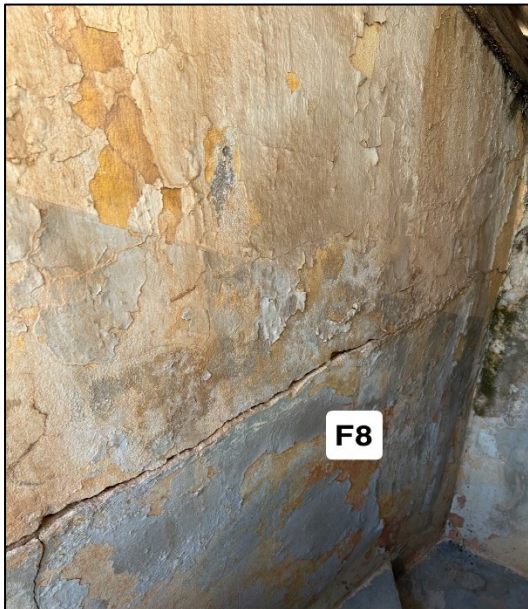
Fissuration horizontale sur un mur en maçonnerie (étage courant)
